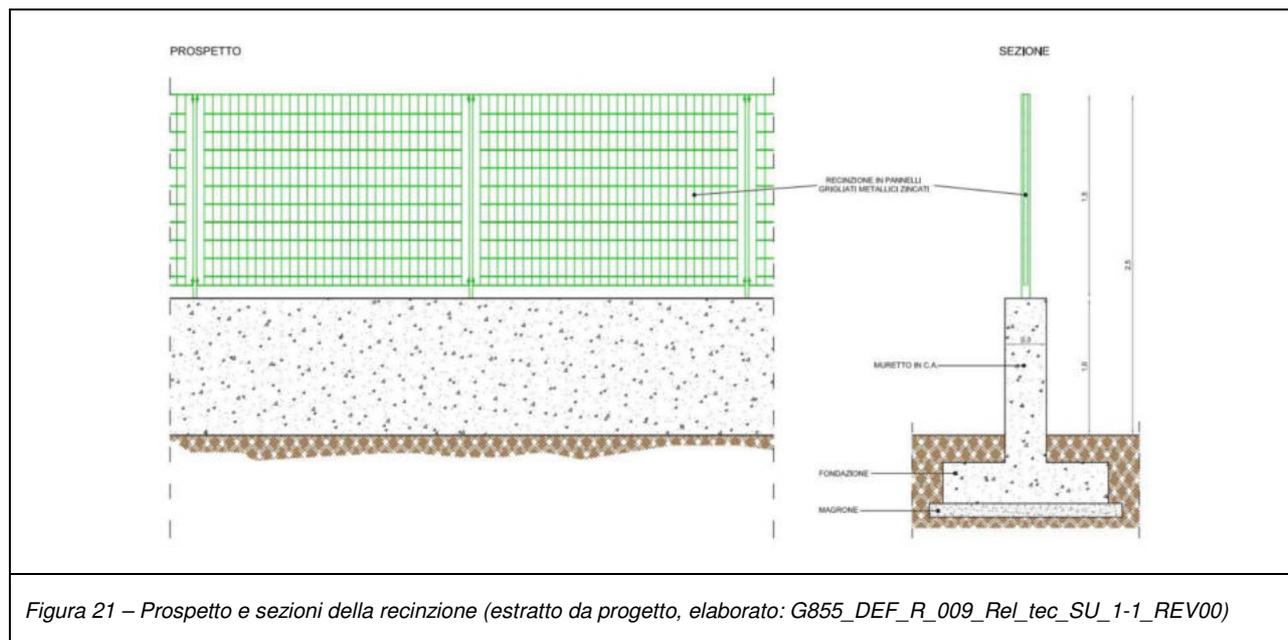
Prospetto e sezioni della recinzione (estratto da progetto, elaborato: G855_DEF_R_009_Rel_tec_SU_1-1_REV00)
